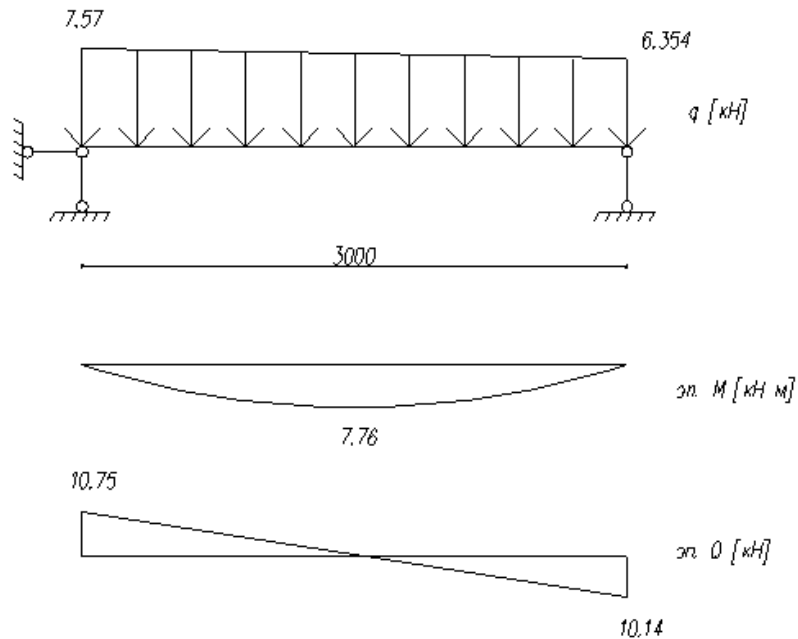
Розрахункова схема і внутрішні зусилля.
